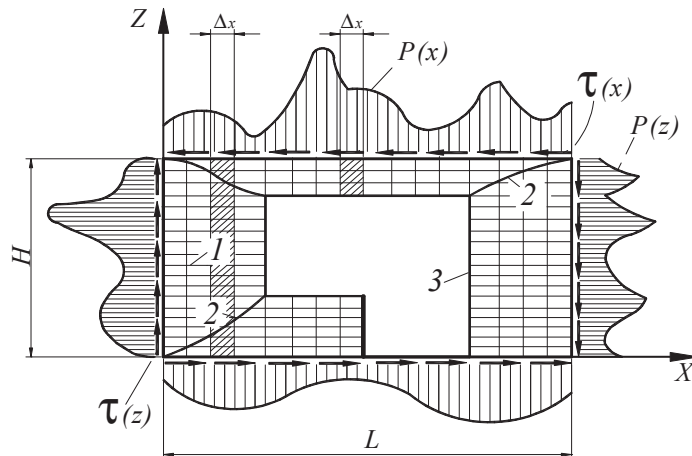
К расчету плосконапряженных железобетонных конструкций с оконными и дверными проемами на сейсмические воздействия:
